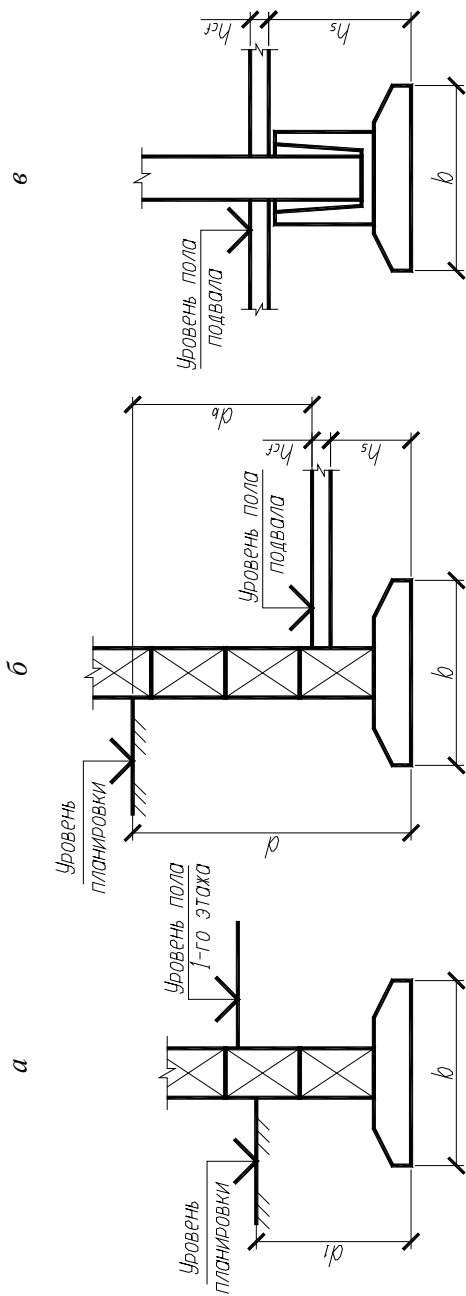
Расчетные схемы для фундамента под наружную стену здания без подвала (*a*), фундамента под наружную стену здания с подвалом (*б*) и фундамента внутренней колонны в подвале (*в*)
